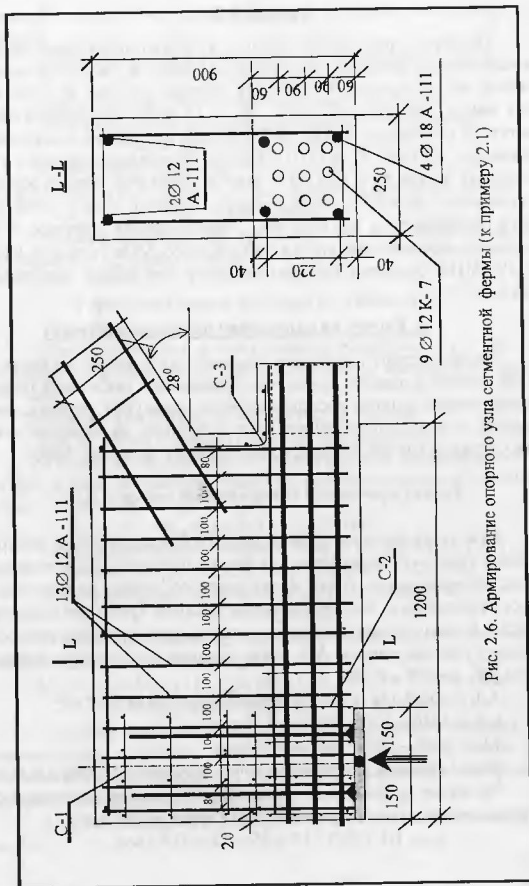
Армирование опорного узла сегментной фермы (к примеру 2.1.)
